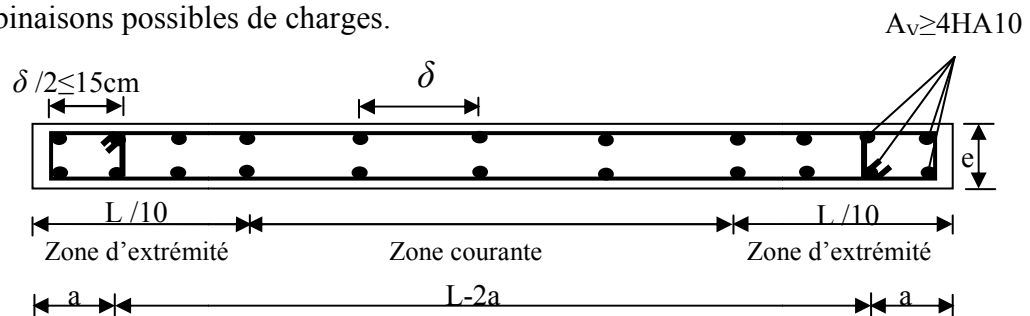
Disposition des armatures verticales dans les voiles.
